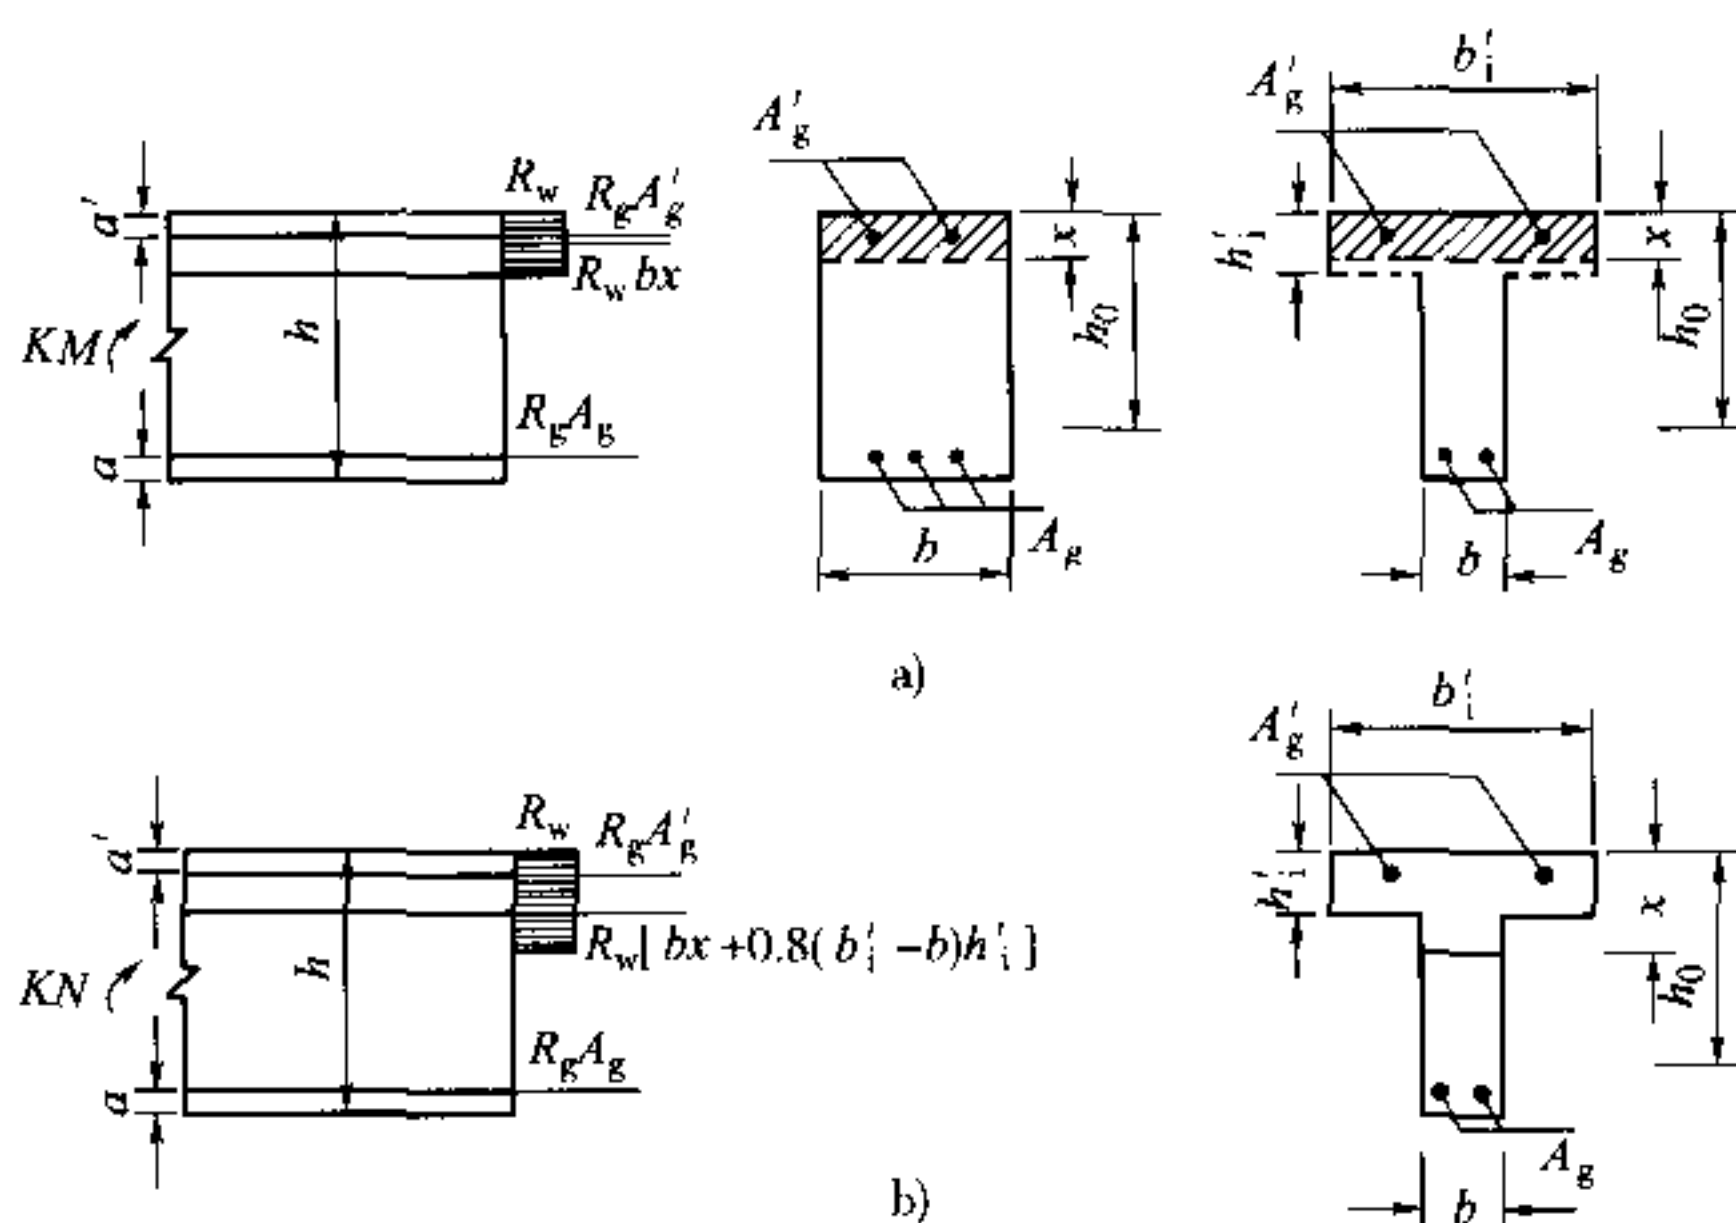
钢筋混凝土受弯构件截面强度计算
